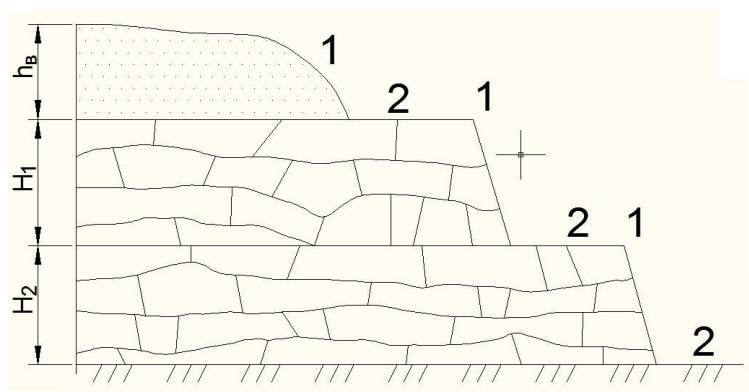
Схема разработки грунтового карьера: h_v – высота уступа вскрыши; H_1 , H_2 – высота верхнего и нижнего добычных уступов; 1 – бровки уступов; 2 – рабочие площадки вскрышного и добычных уступов
